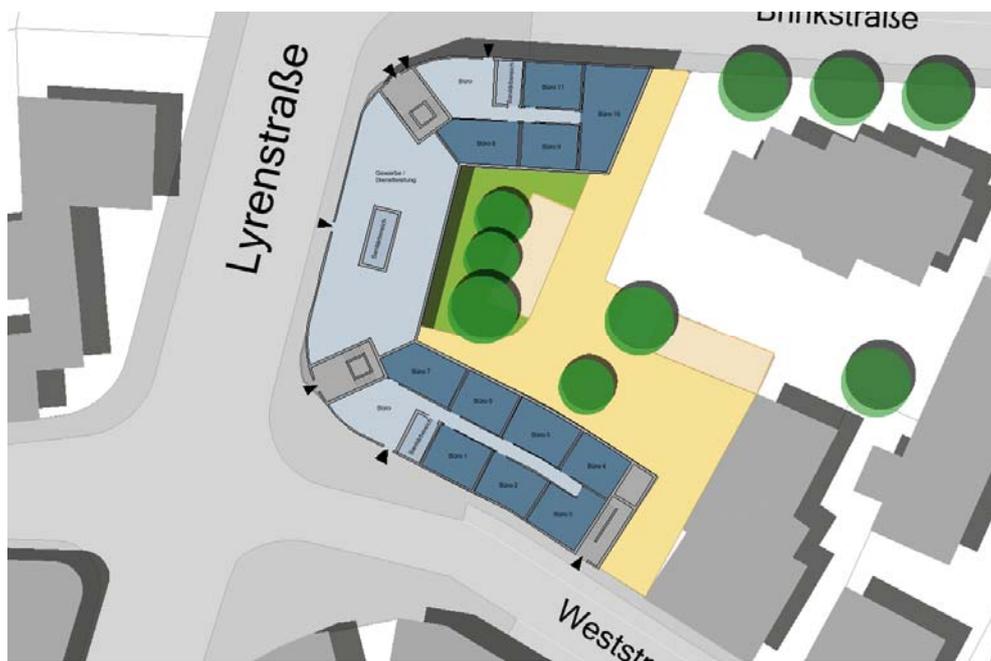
Beispielhafte Grundrissorganisation im Erdgeschoss für Büro-, Dienstleistung oder Handel
